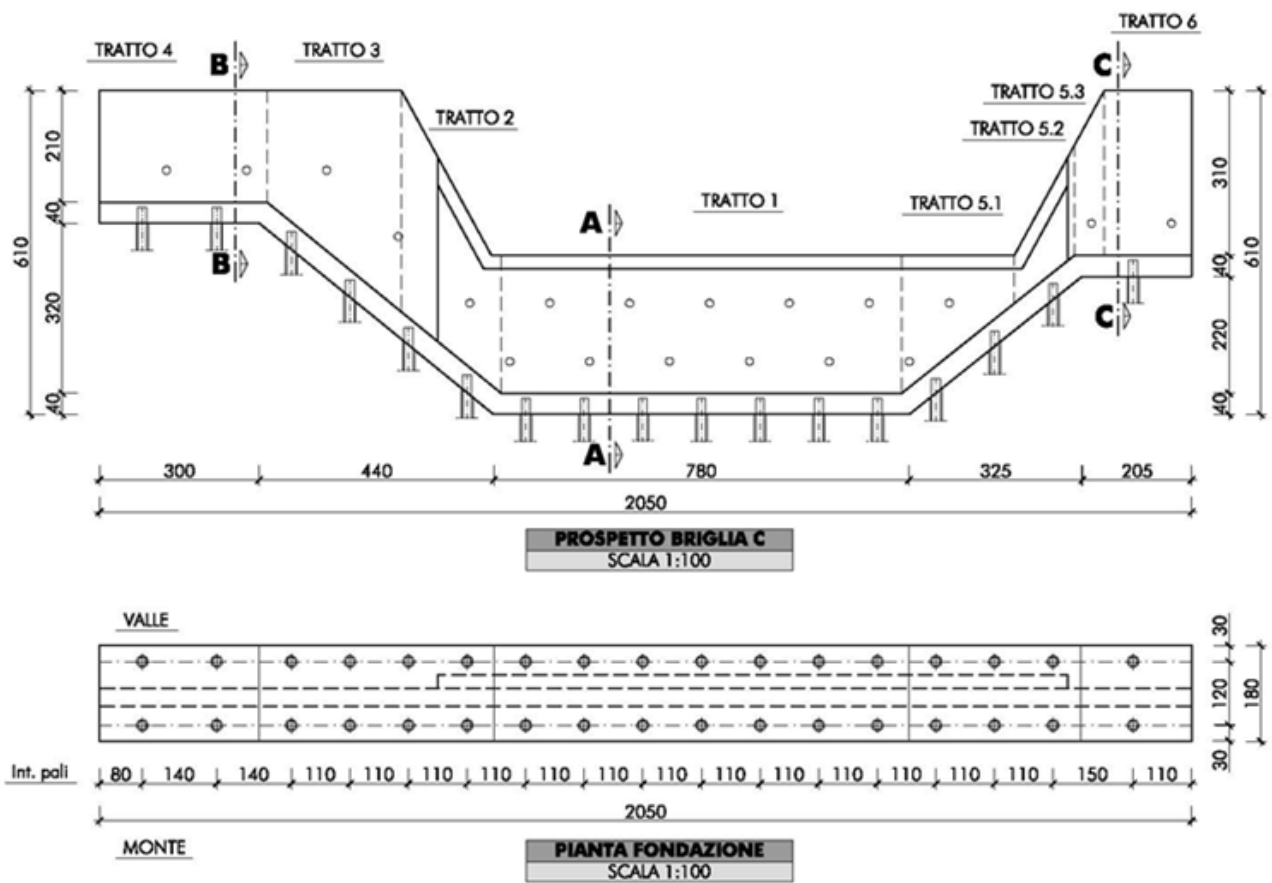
Pianta e sezione di un tipologico di briglia in calcestruzzo armato su fondazioni profonde.
